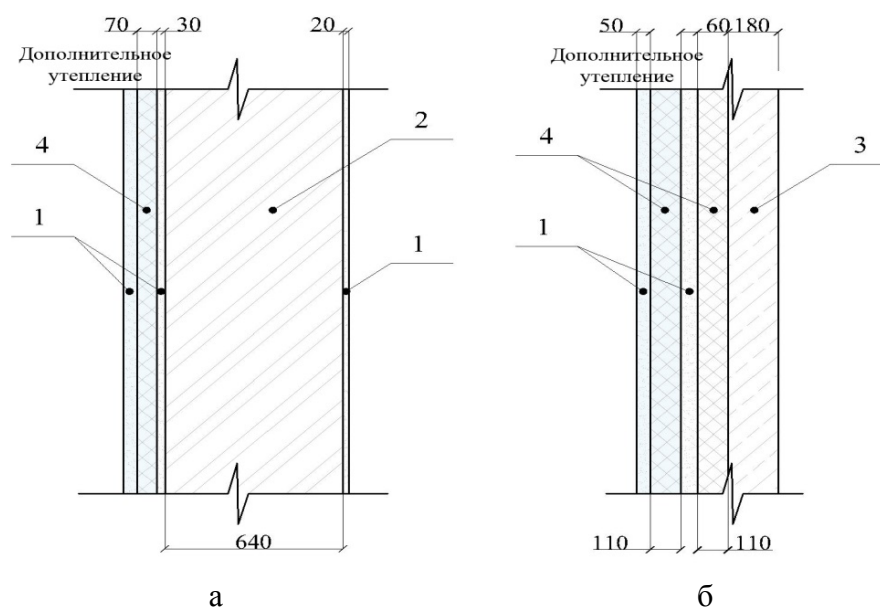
Типовые узлы с дополнительным утеплителем: а – узел из кирпича, б – узел из железобетонных панелей; 1 – штукатурка, 2 – кирпич, 3 – железобетон, 4 – утеплитель
